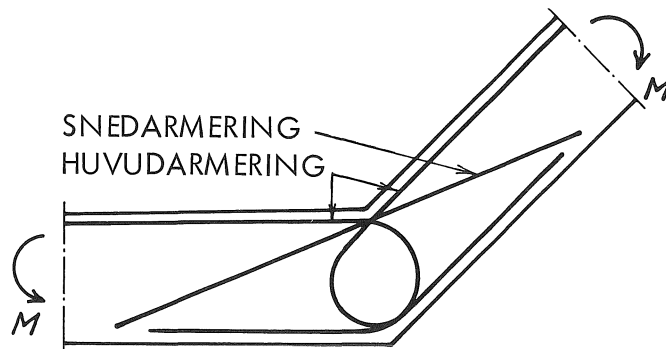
Armeringsutformning vid trubbvinkligt ramhörn.
